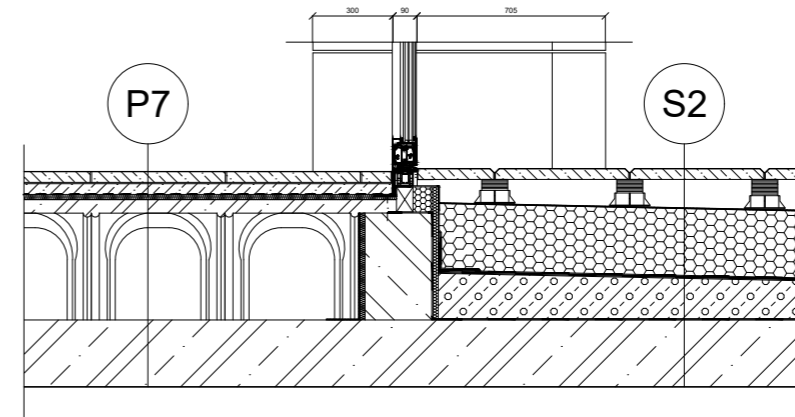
DETAIL RÁMU U ZIMNÍ ZAHRADY, 1:10
